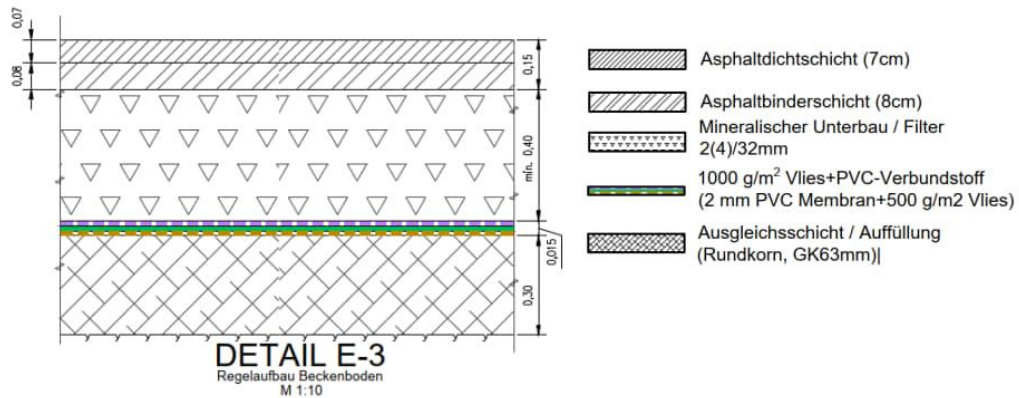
Regelaufbau Dichtsysteme Beckenboden (Ausschnitt aus Plan [P15][P15] , Detail E-3)
